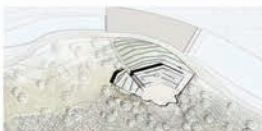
Plan de situație - AMFITEATRUL "STONE NEST" DIN WEIHAI
